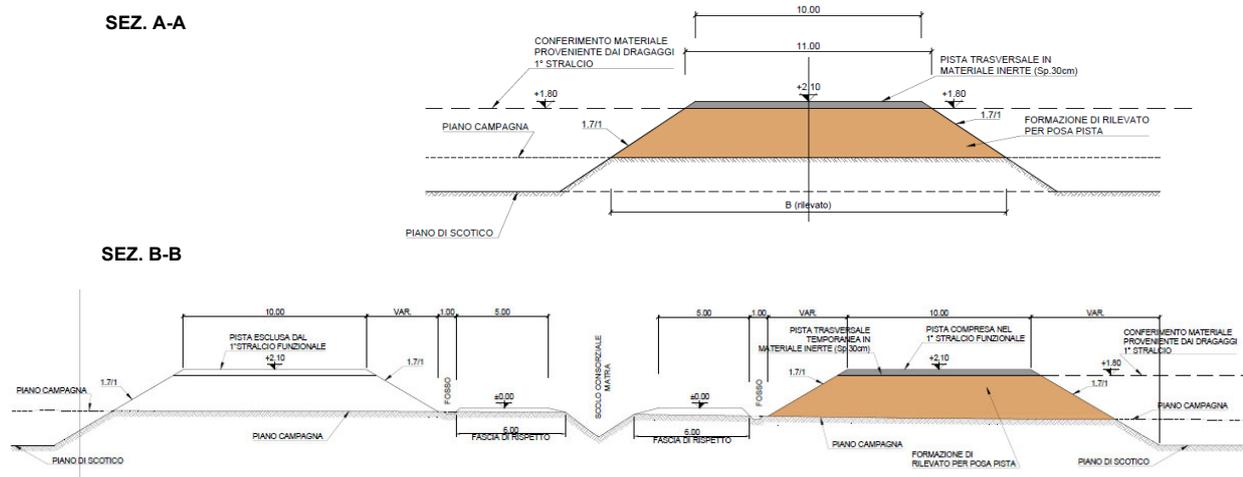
Sezioni tipo: A-A (sopra) e B-B (sotto)
